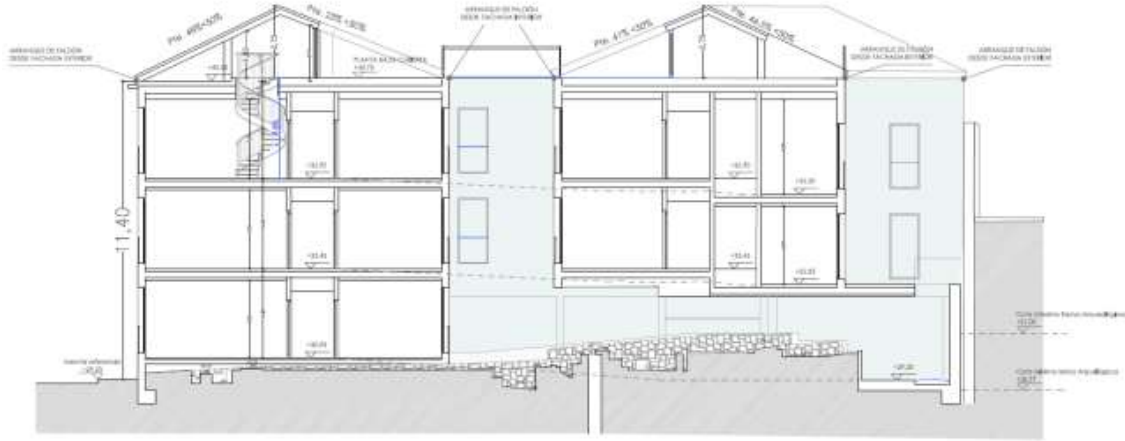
Esquema de la sección propuesta incluida en el Plano ED-07.
